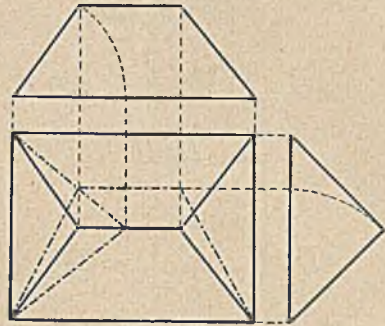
Walmdach. (Die Walmflächen sind steiler als die Hauptdachflächen.)
